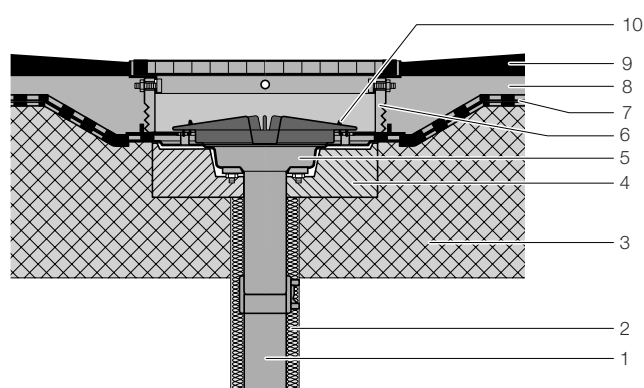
Конструкция монолитной кровли, не изолированной, с битумным кровельным покрытием, пригодным для передвижения транспортных средств
